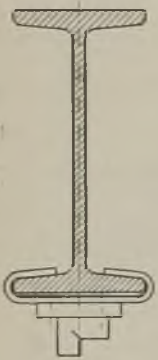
Befestigung der Deckenscheibe an den eisernen Träger (Betondecke) mittels Bänderisen-Klammer. Die Deckenscheibe ist angenietet.
